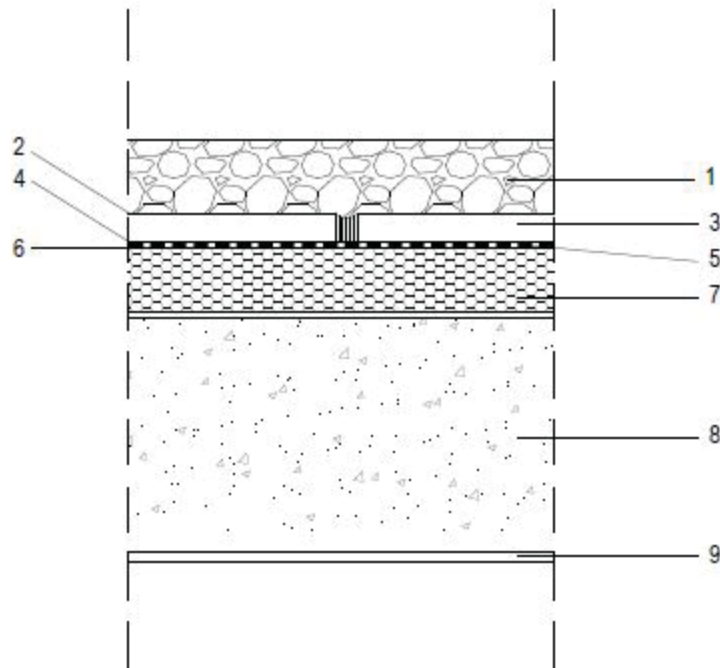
Detalle cubierta invertida 2. Fuente: Elaboración propia-CAD
